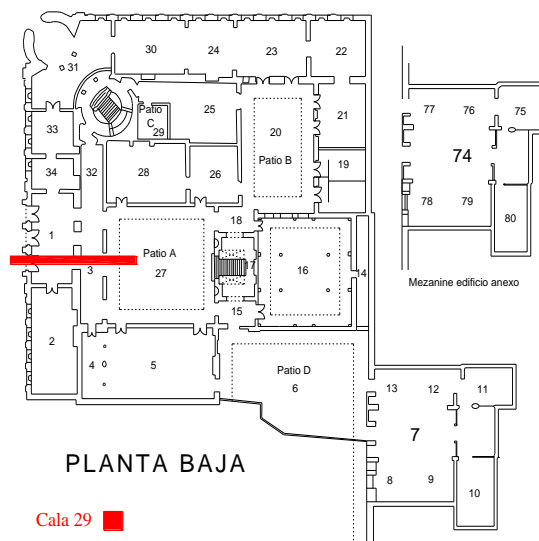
Plano en planta del Palacio de la Autonomía con la ubicación de la cala 29.
